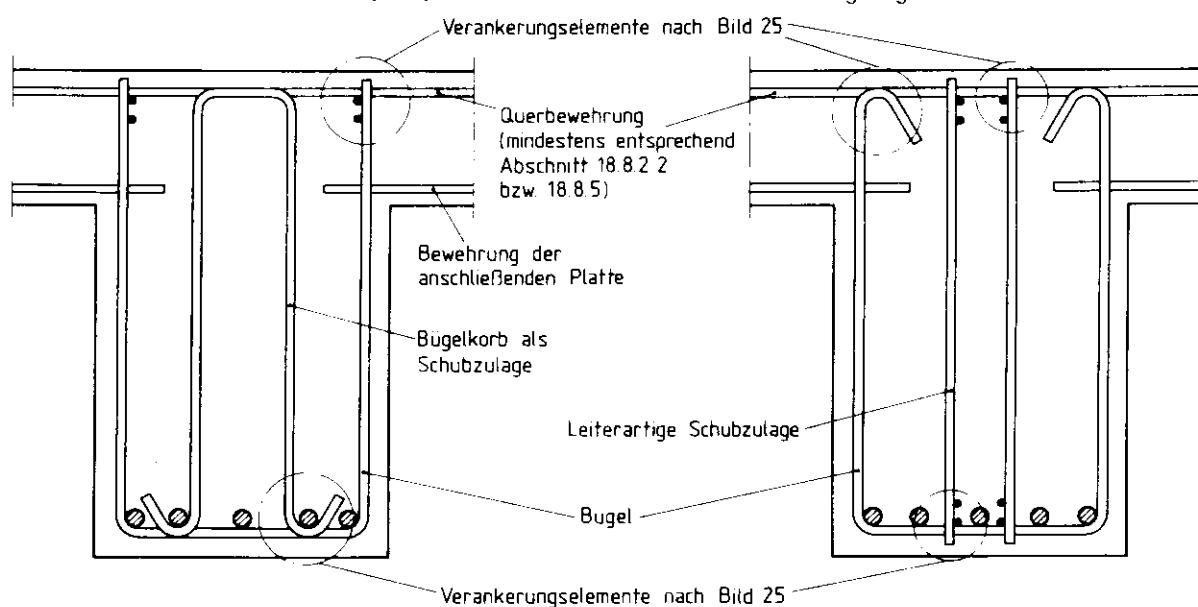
Beispiel für eine Schubbewehrung aus Bügeln und Schubzulagen in Plattenbalken
